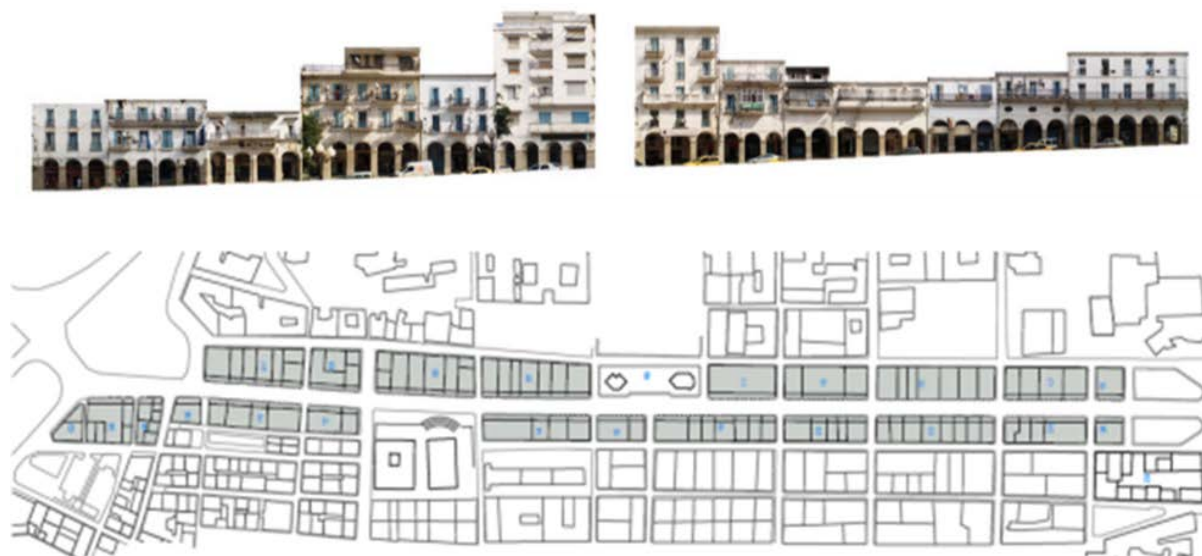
Alzado fotográfico parcial y planta general de la Rue Didouche Mourad
